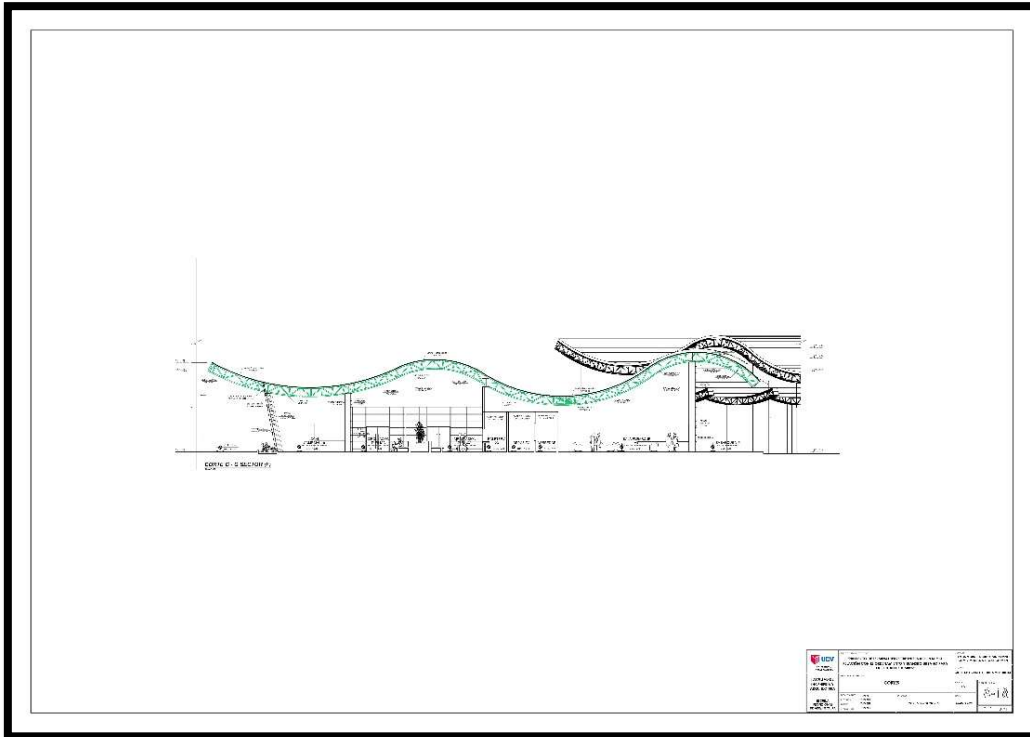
Plano Cortes G-G; Sector (F). Fuente: Elaboración Propia.
